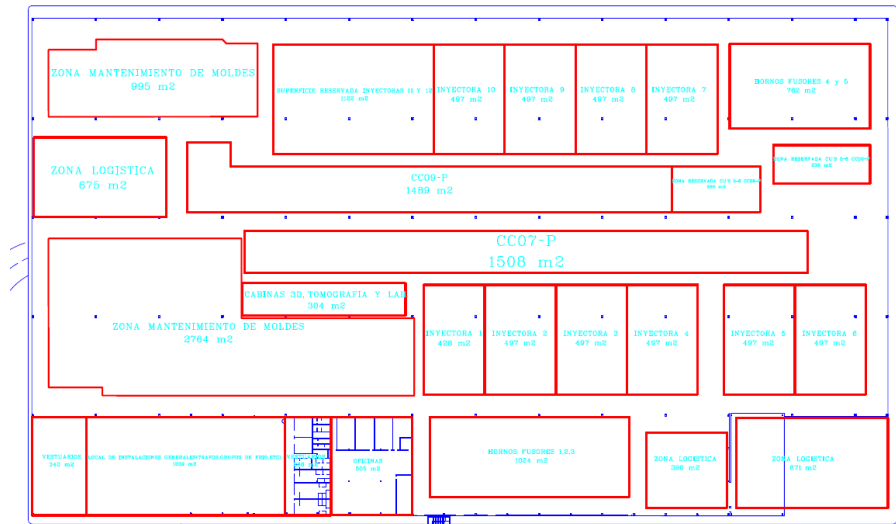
21 Plano Planta de Inyección Valladolid [Doc. Interna Renault]
